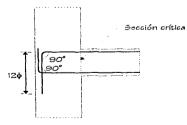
Anclaje de barras longitudinales en nudos extremos
